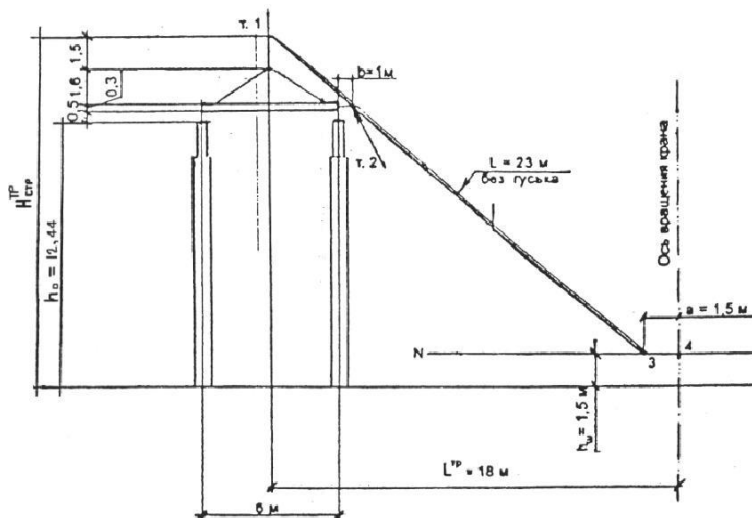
Построение схемы монтажа плиты покрытия самоходным стреловым краном.
